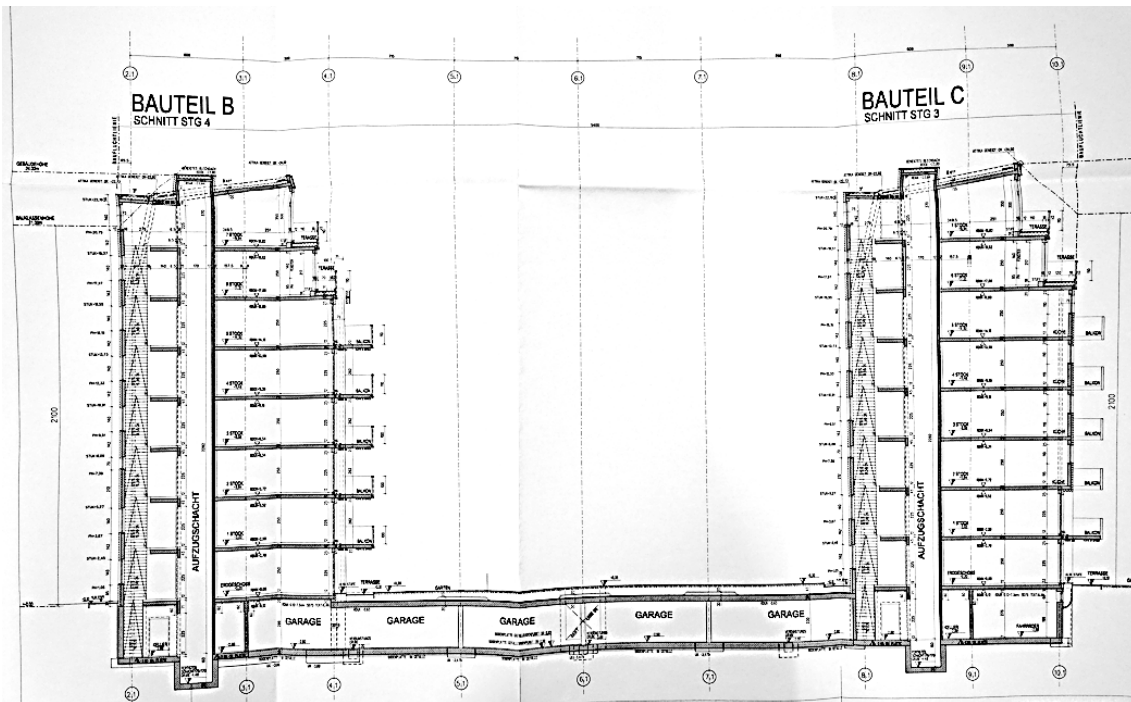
Auszüge Bestandsplan (Fertigstellungsanzeige), Plan Nr.: 13
